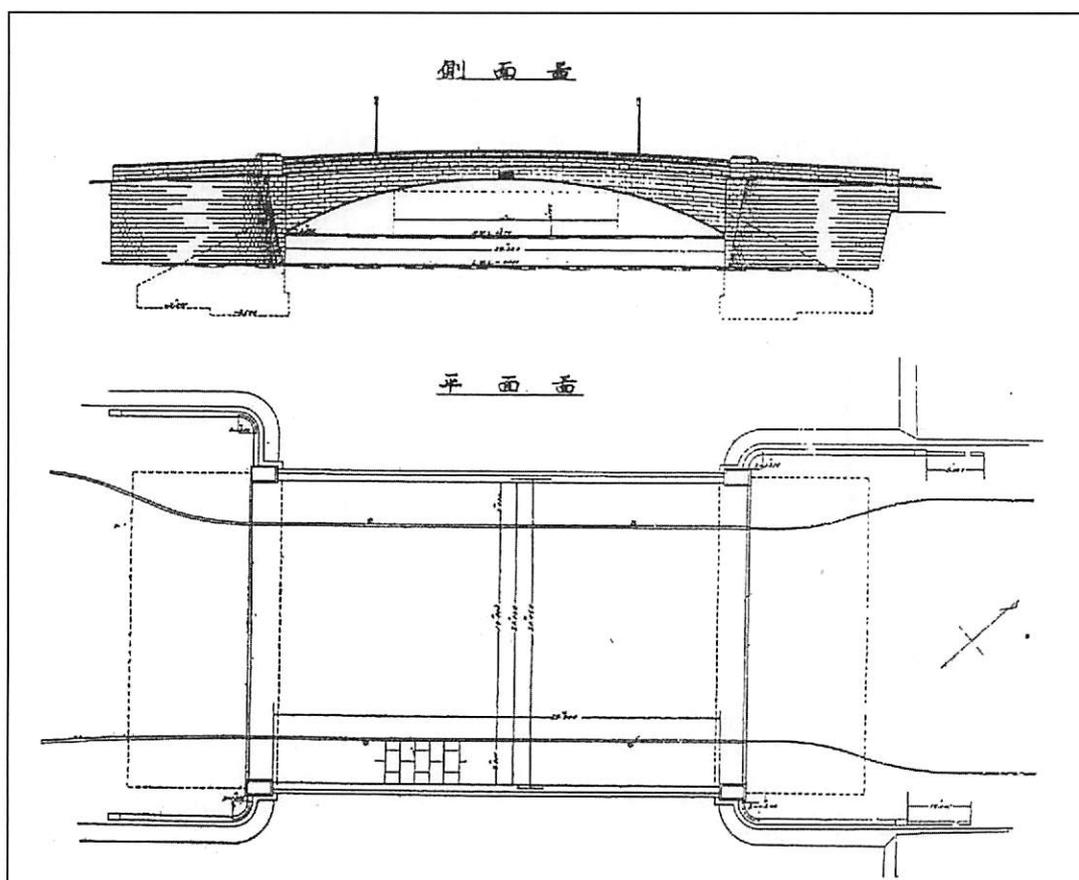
竣工時の万国橋の側面図および平面図
